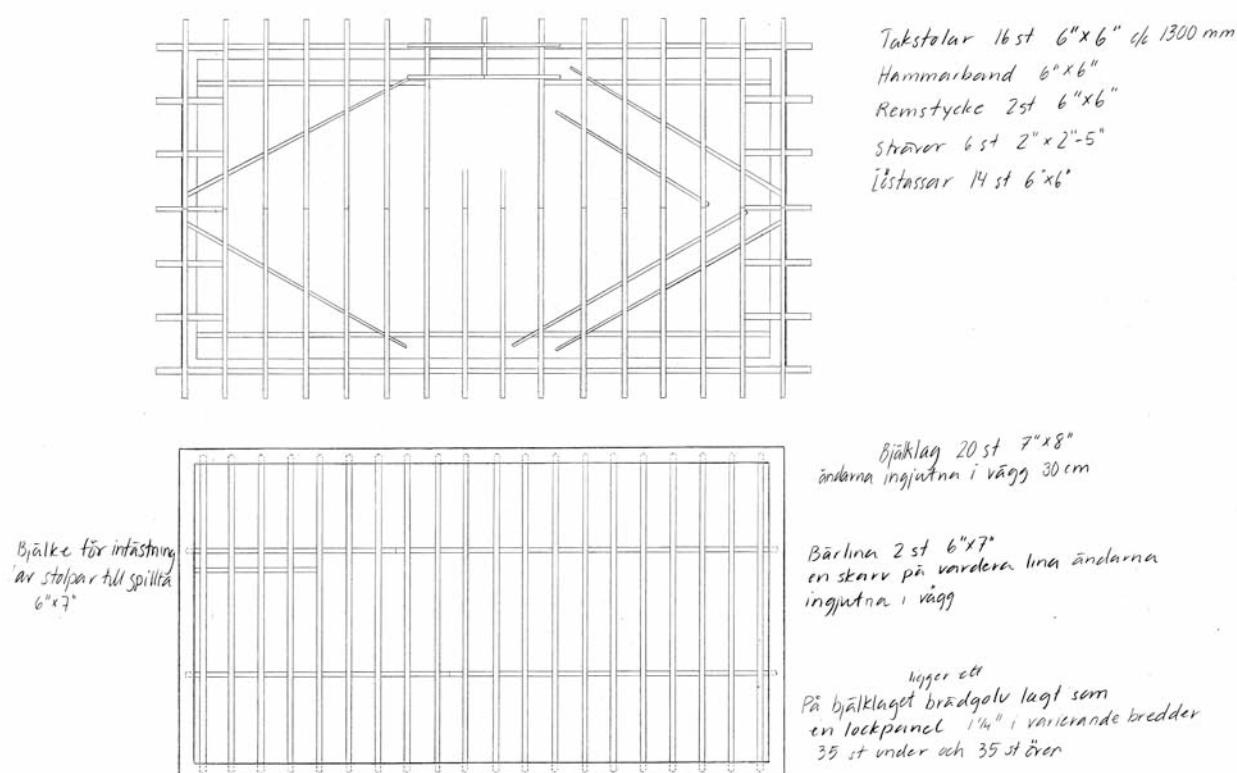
Överst takplan med takstolar, strävor, murrem och remstycken. Här saknas mötet mellan lastkupan och det övriga taklaget. Under visas ett plan men bjälkar och bärlinor. Uppmätningssritning av Ann-Sofie Svensson.
